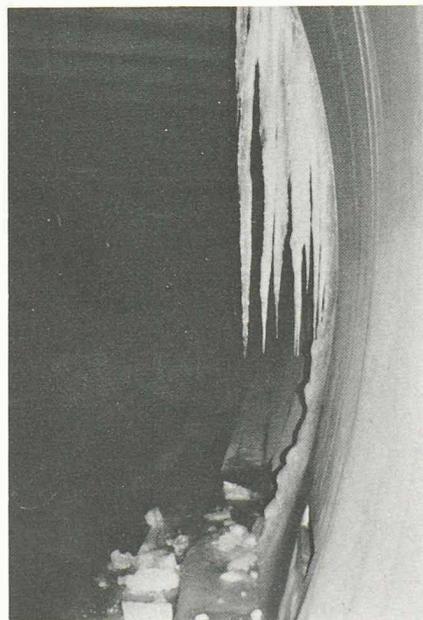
Formation de glace à la suite d'infiltrations d'eau à travers des joints et des fissures, par manque d'étanchéité.
